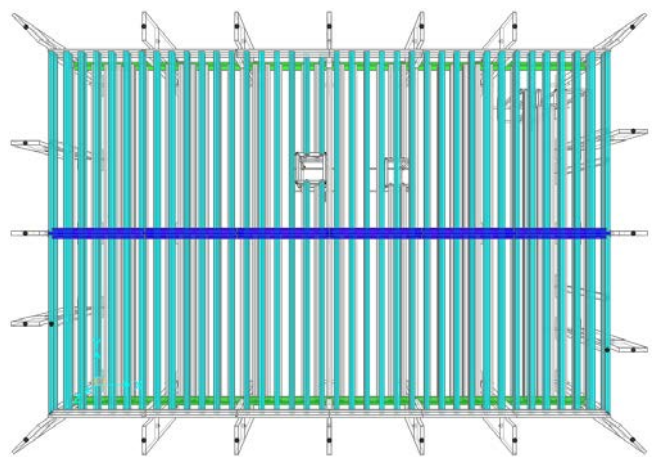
Pianta prospettica del modello FEM della soluzione di adeguamento sismico progettata.
